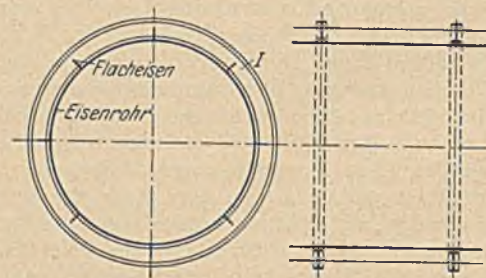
Eisenrohr mit Quer- u. Längsversteifungen.
